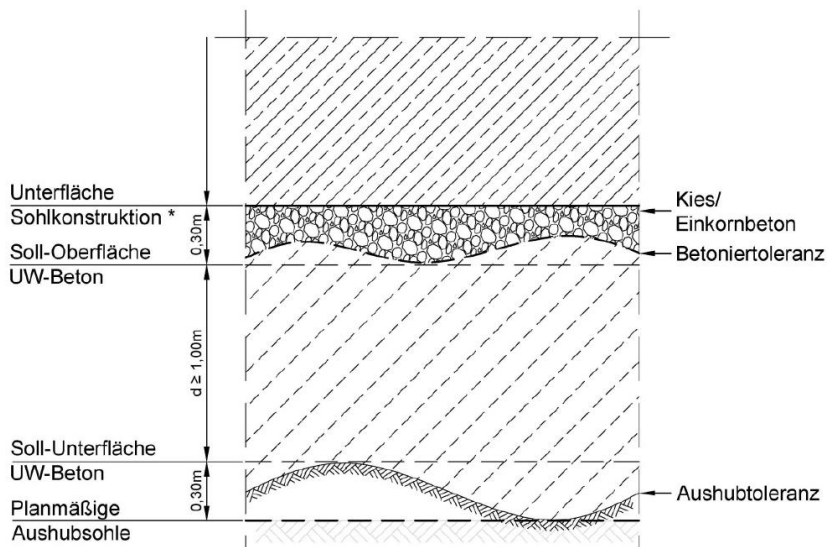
Darstellung der Ausführungssituation für eine Unterwasserbetonsohle gem. Teil 2 – ZTV-ING [37]
